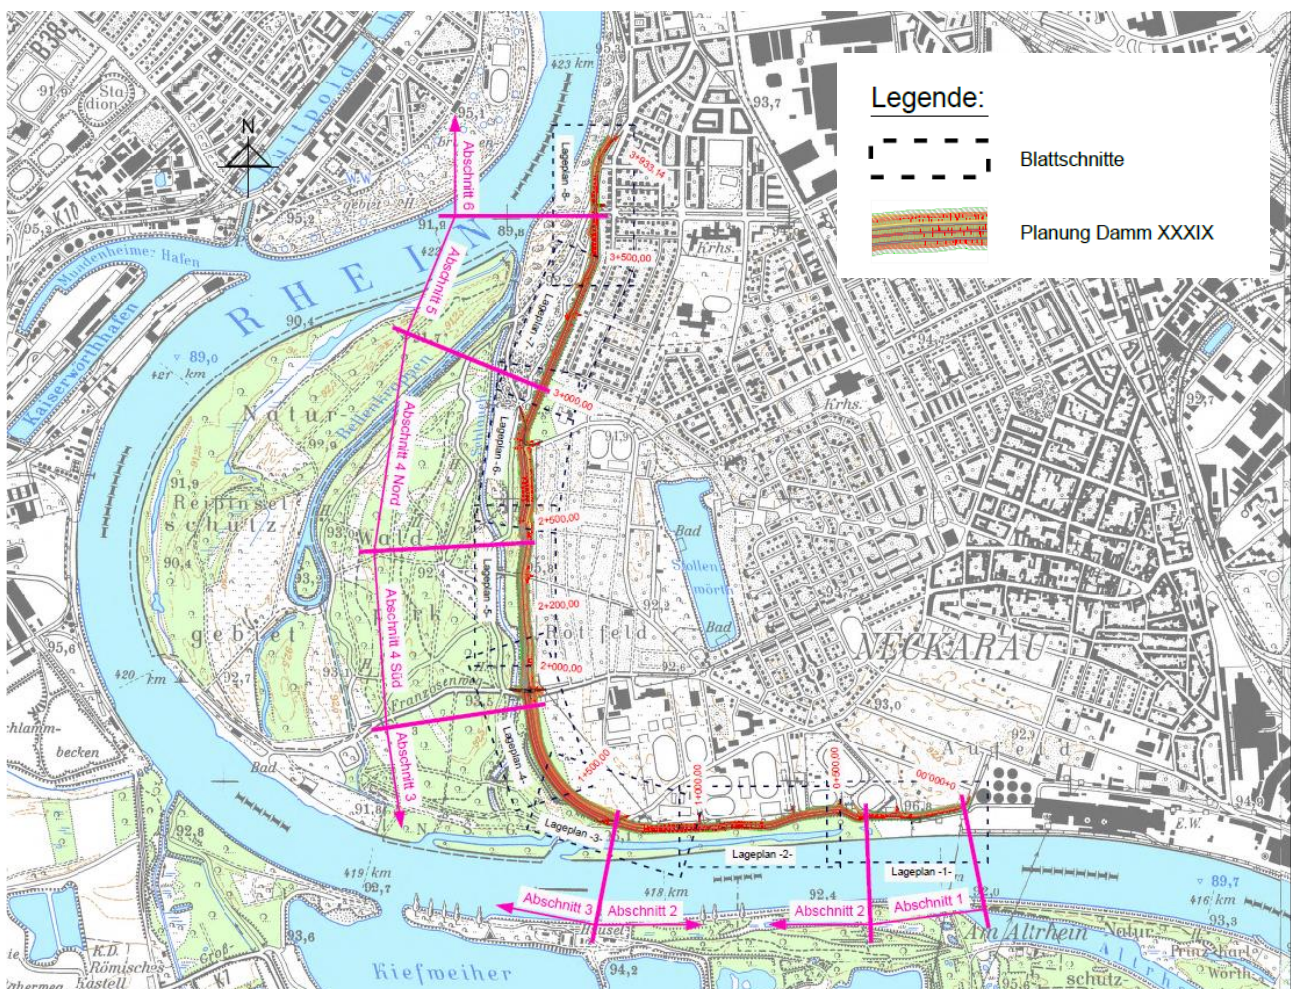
Lageplan und Übersicht Dammverlauf und Abschnitte
